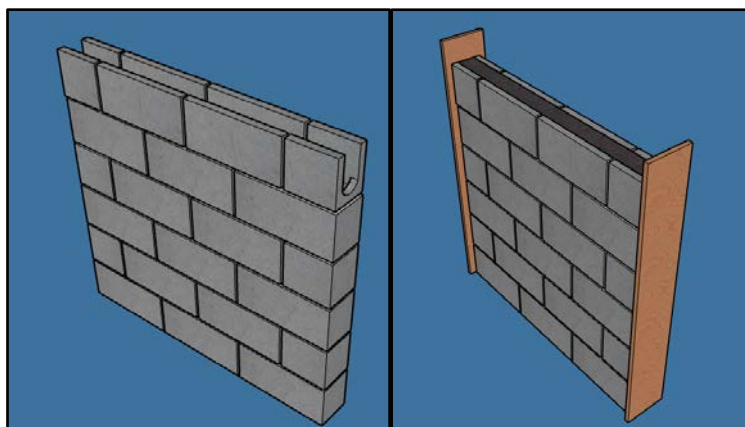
Esquema de utilização do graute no preenchimento de vigas de alvenaria estrutural, modelo construído no Sketch-Up 2018. FONTE: Arquivo pessoal
